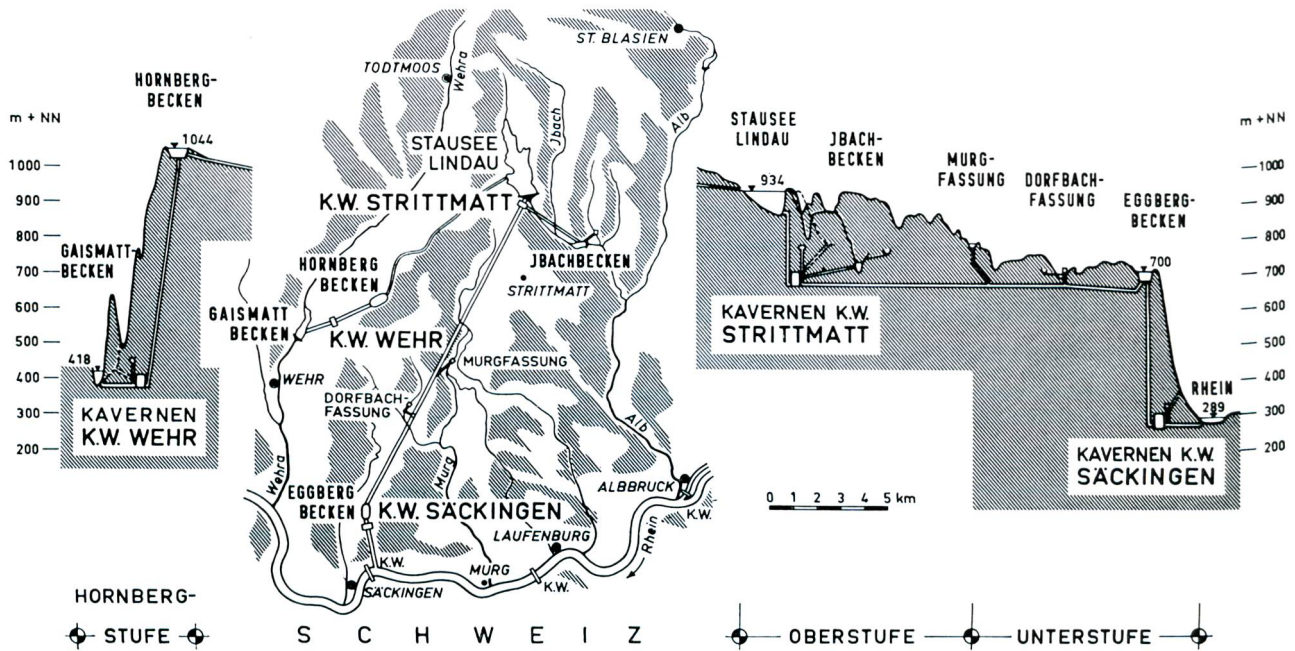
Hotzenwaldgruppe, Lageplan und Längsschnitte
